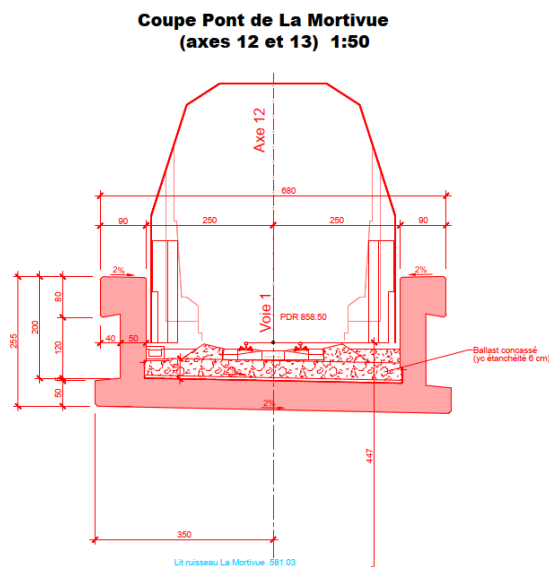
Section en auge proposée pour le nouveau pont sur la Mortivue
